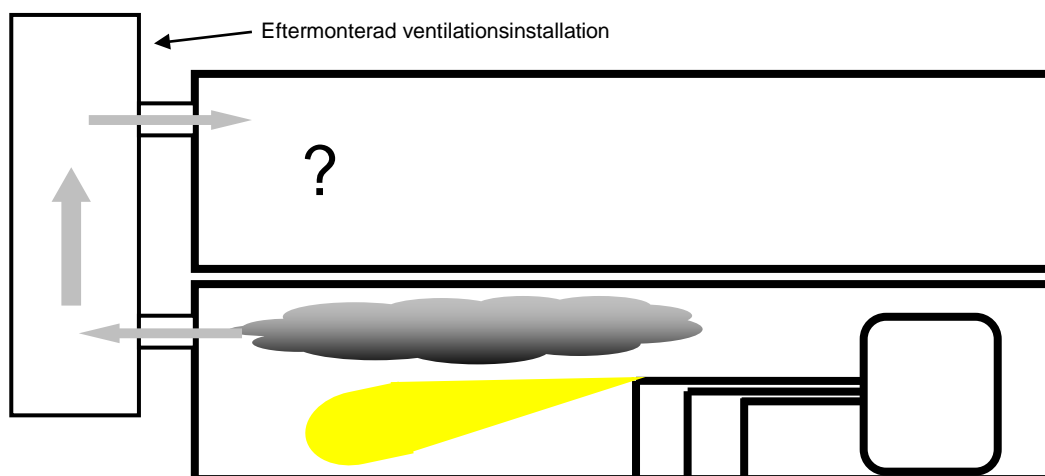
; Illustrering av brandgastransport mellan två plan med och utan en extern installation.
